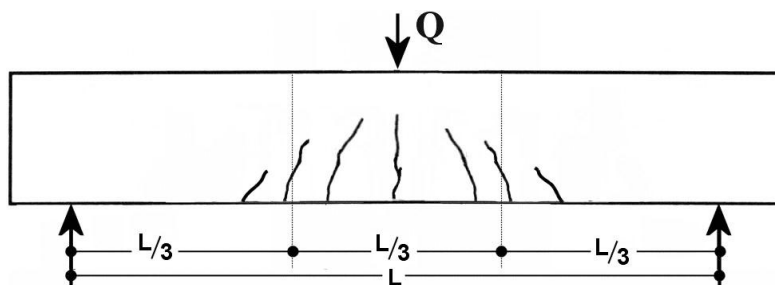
5. Rupture par flexion d'une poutre en BA. [46]
